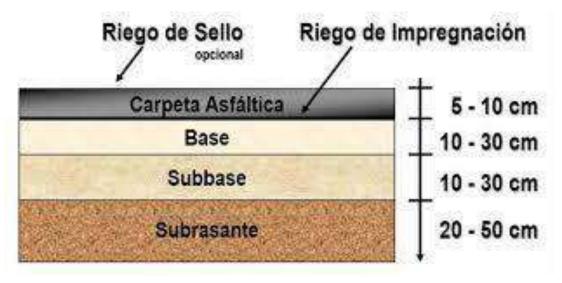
Compuesto de capas estructurales del pavimento flexible Nota: Tomado de "Construcción de capa de subrasantes", por Albarez (2016)
